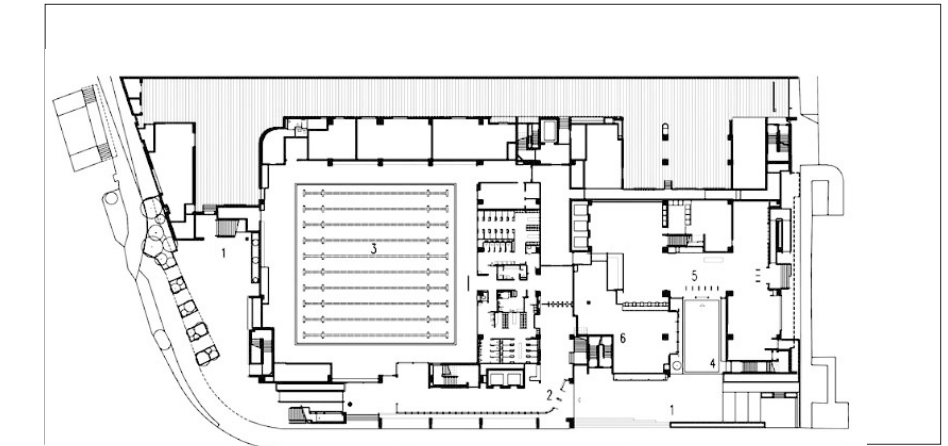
Planimetría Edificio cultural y de ocio Ping Shan Tin Shui Wai
